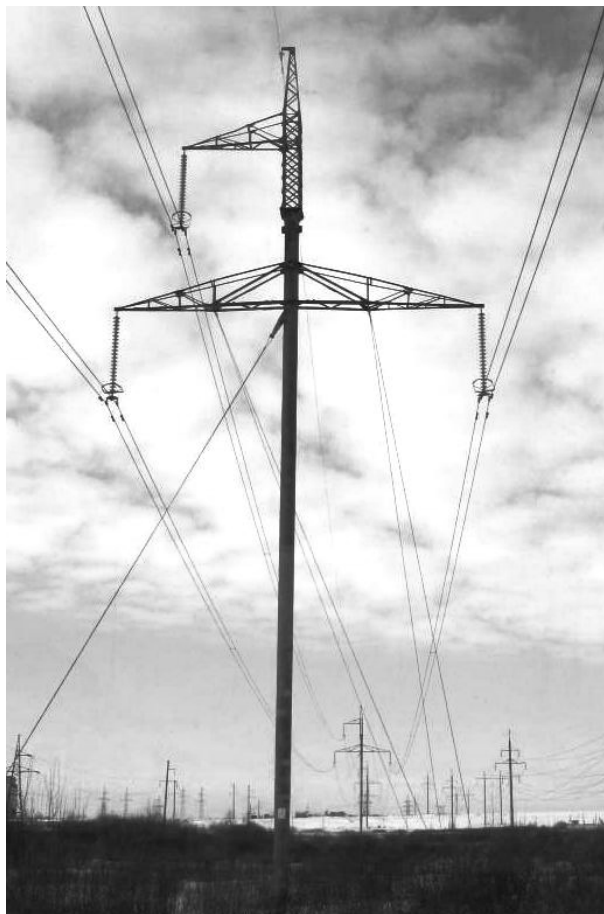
Залізобетонна проміжна опора ПЛ 330 кВ
